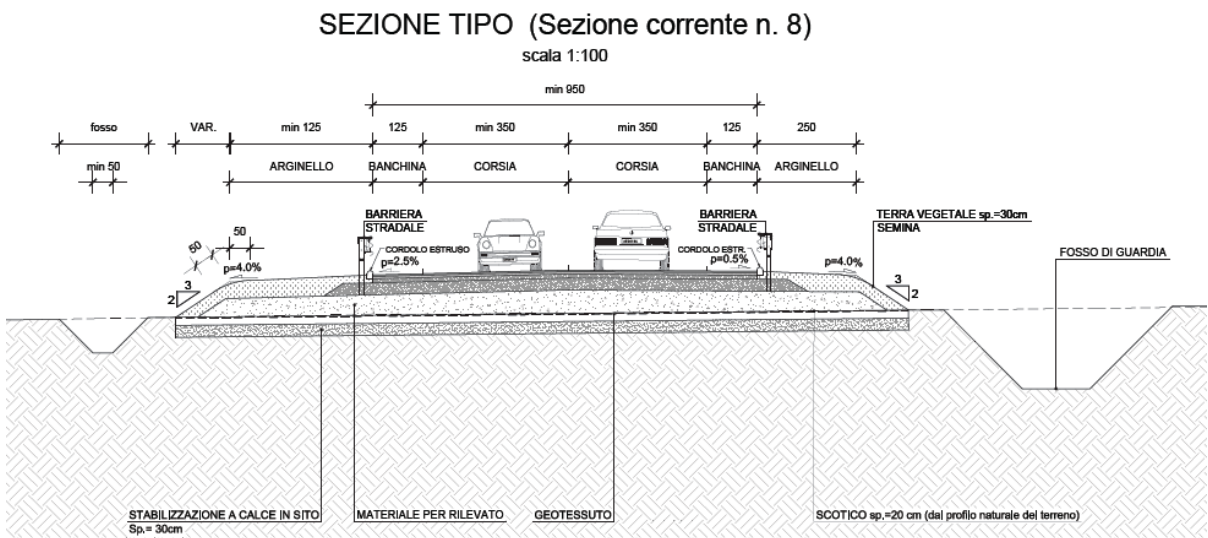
Sezione tipo piattaforma C2 in rettilineo
